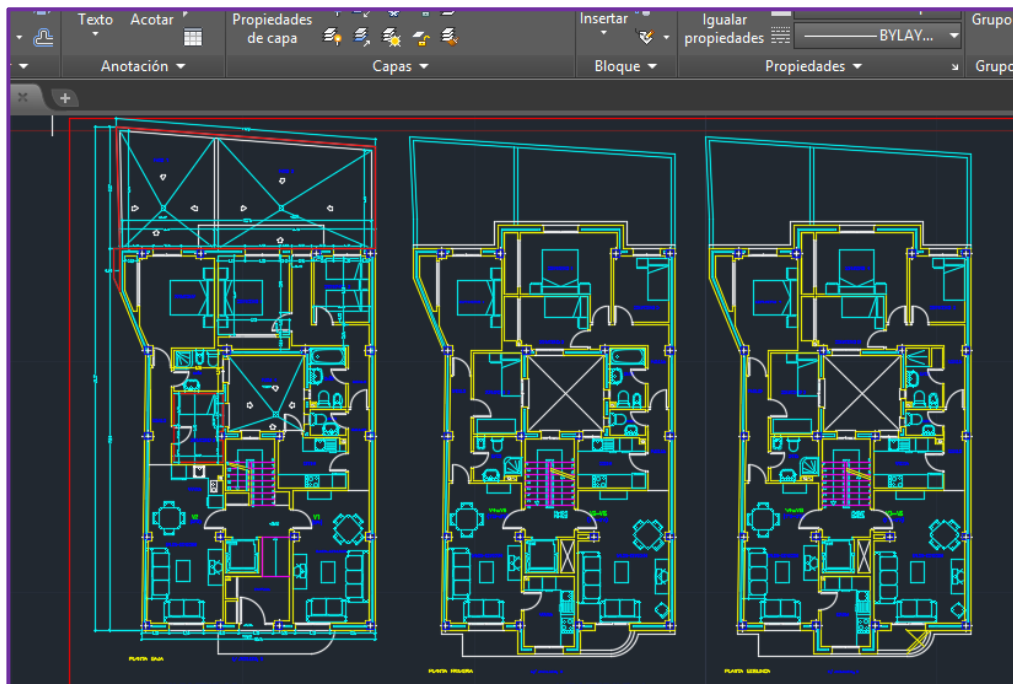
Planos de distribución de cada planta en AutoCAD (Fuente propia)
